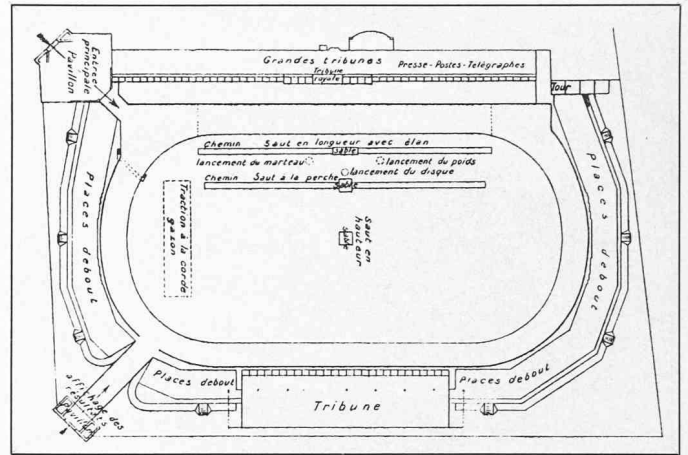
Beerschot Stadion in Antwerpen. Grundriss
